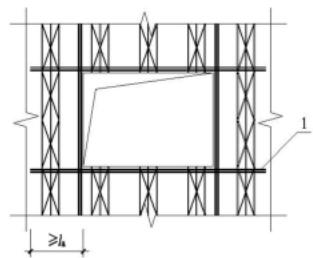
钢筋桁架楼承板组合楼板开洞构造措施
